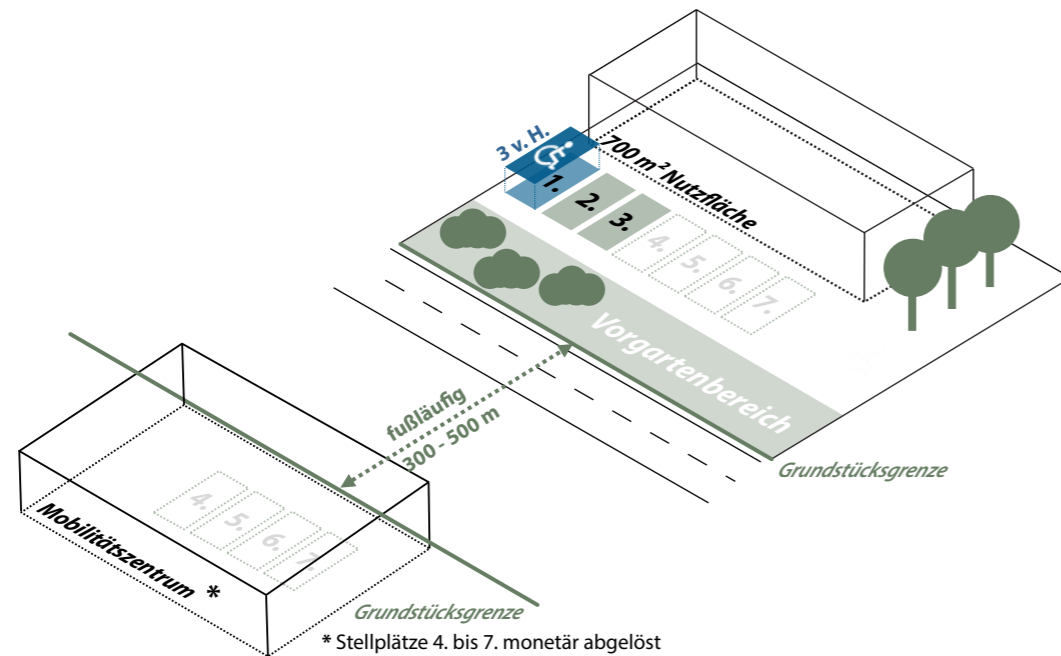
Schem. Darstellung der ermittelten Stellplatzanzahl
